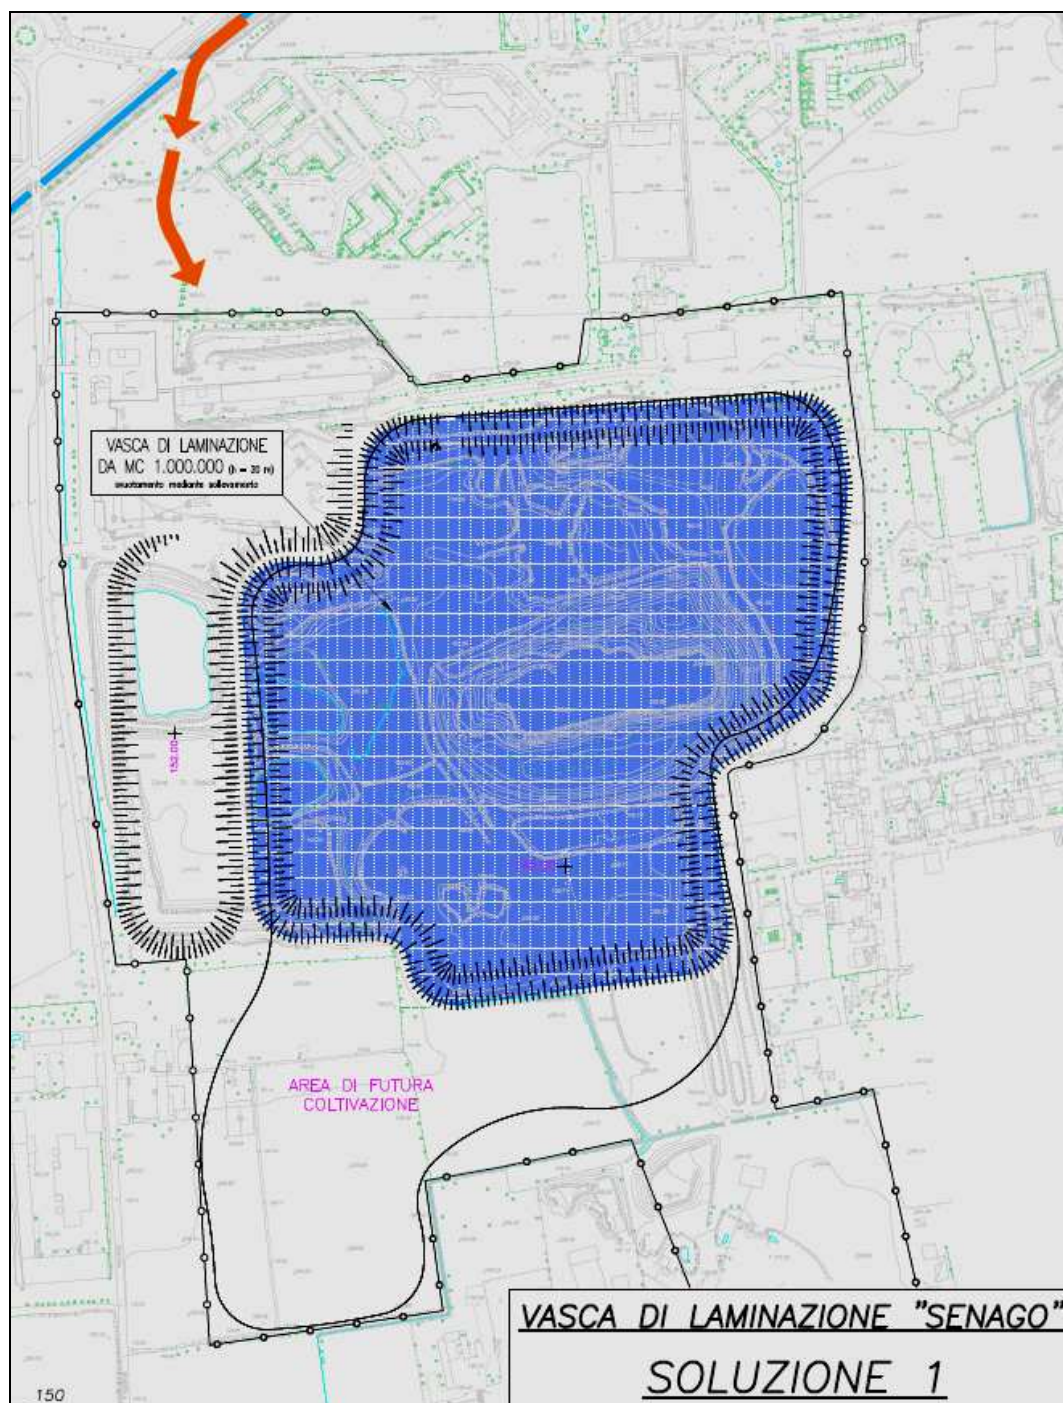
Alternativa n. 1. Vista di dettaglio.
